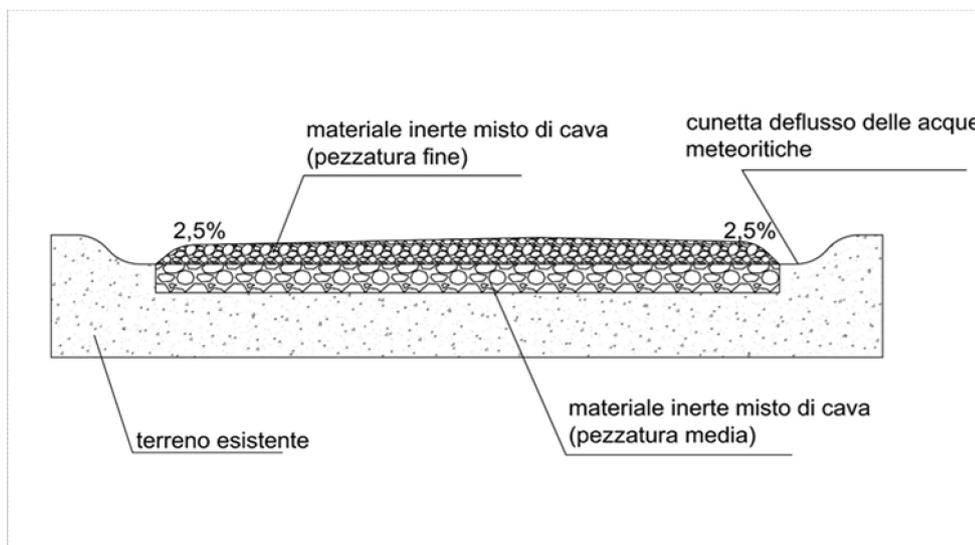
Planimetria e particolare della sezione della nuova viabilità interna
